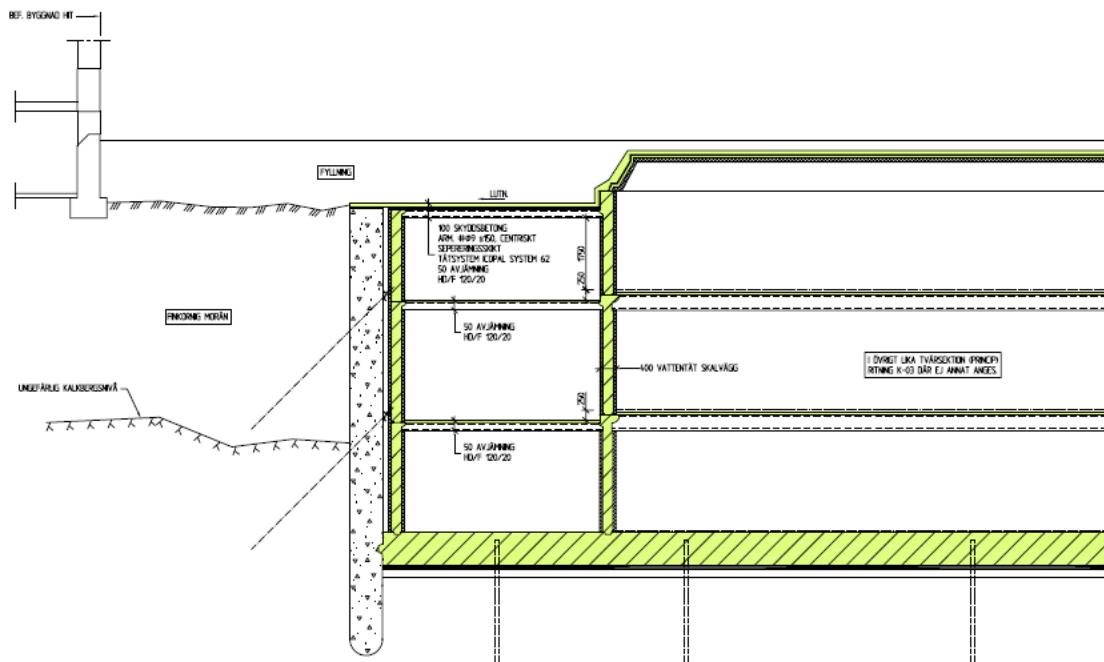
Principsektion för parkeringsgaraget enligt detaljplan 4866.
